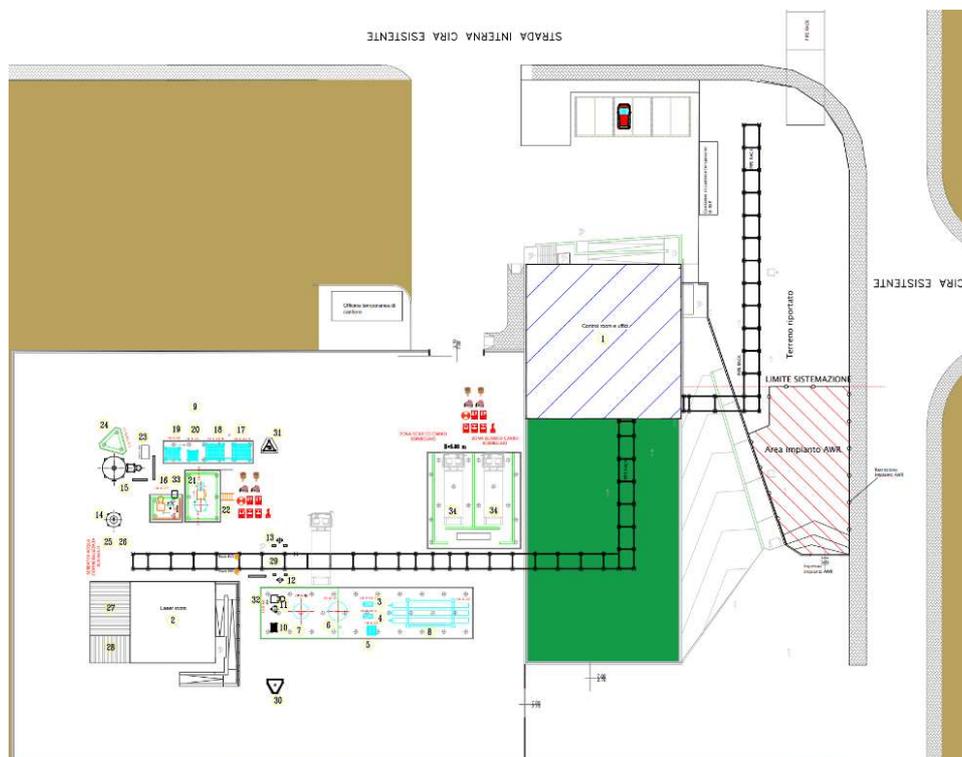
Planimetria zona di interesse per la realizzazione dell'AWR.
